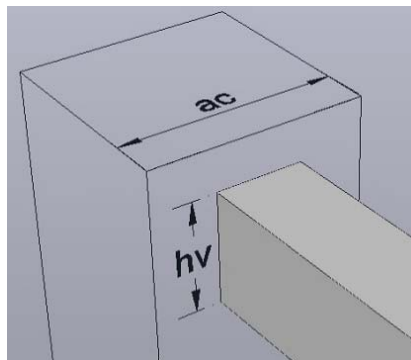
Relación entre el ancho de la columna (a_c) y la altura de la viga (h_v).
